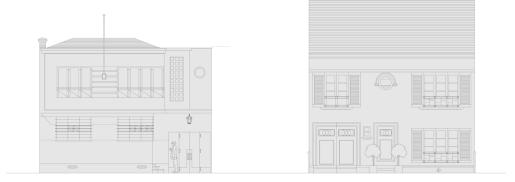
Levantamiento de fachadas originales de la calle General Holley. Elaboracion Propia
